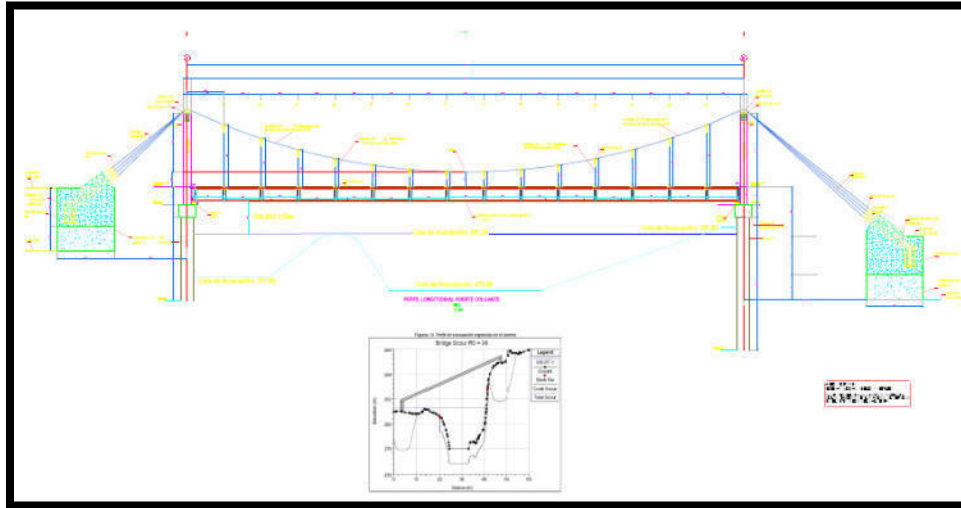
“plano estructural del puente vehicular sobre el río El Afilador”
